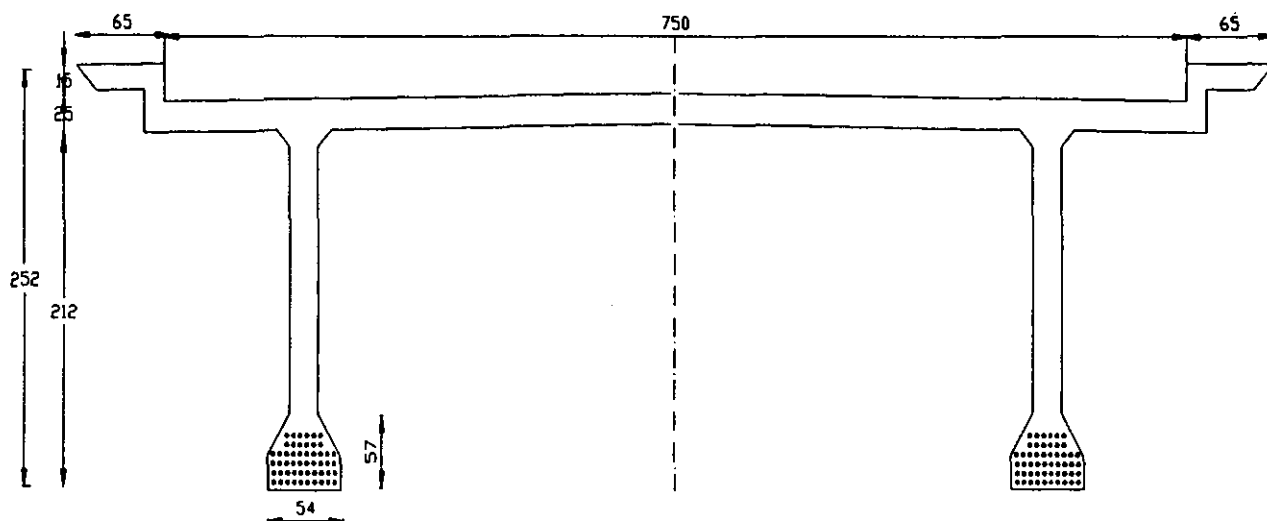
Losa con dos nervaduras de concreto reforzados (SAHOP, 1963)
